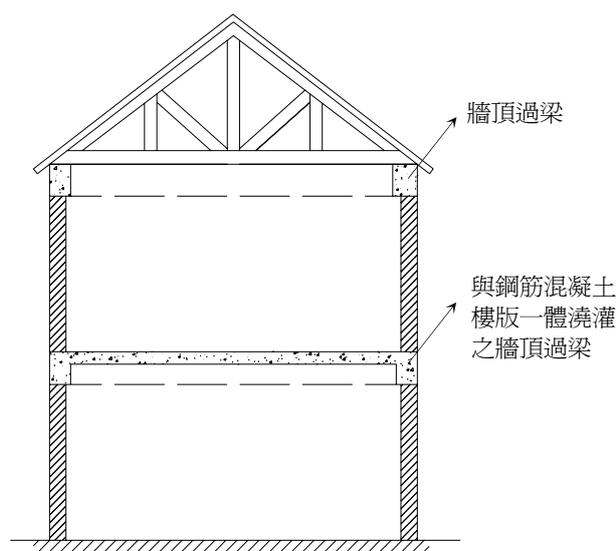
結構牆頂配置鋼筋混凝土過梁
